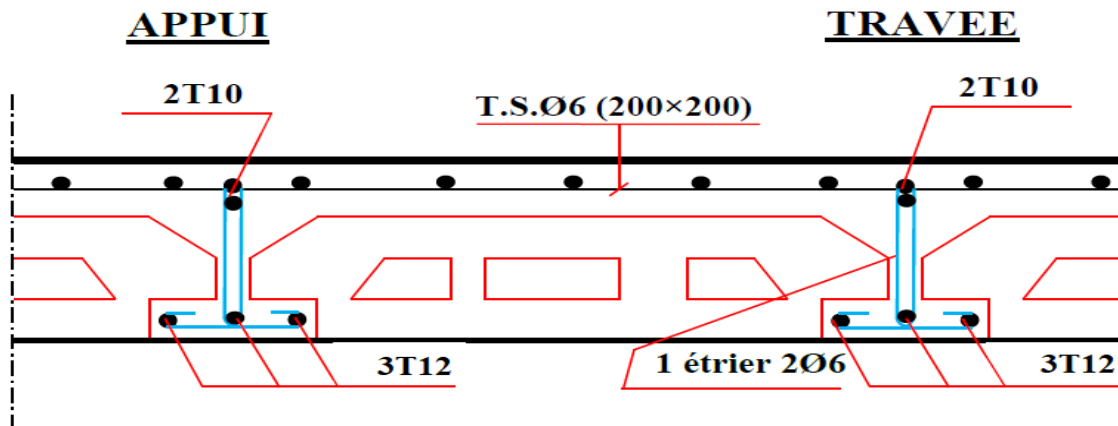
Schéma de ferrailage de poutrelle Type 02 (Etage).
